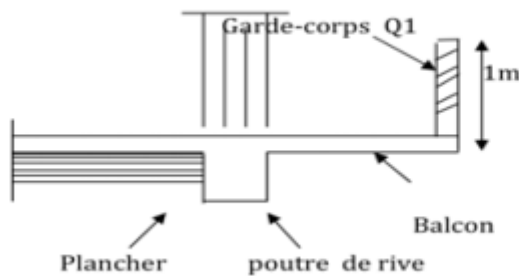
Coupe verticale d'un balcon Figure III.19 : Schéma statique du balcon
